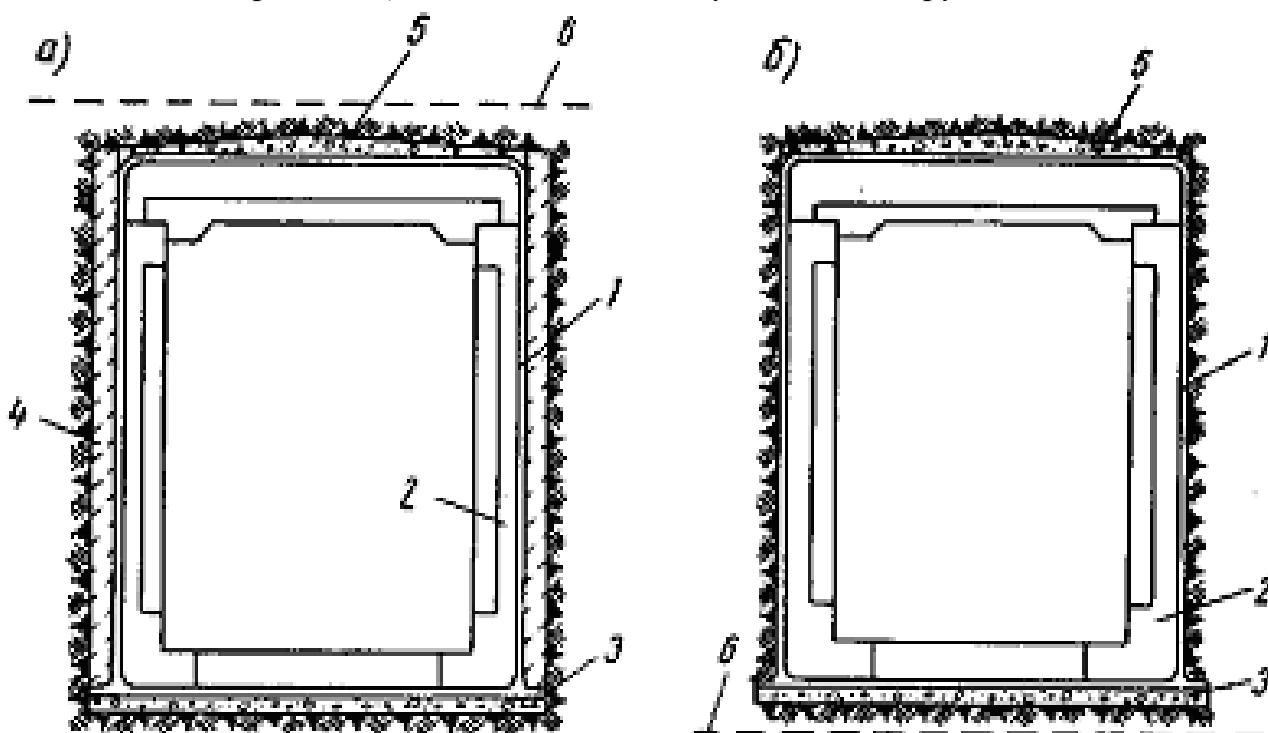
Схема гидроизоляции подземных сооружений: а – от напора грунтовых вод; б – от грунтовой капиллярной влаги.
